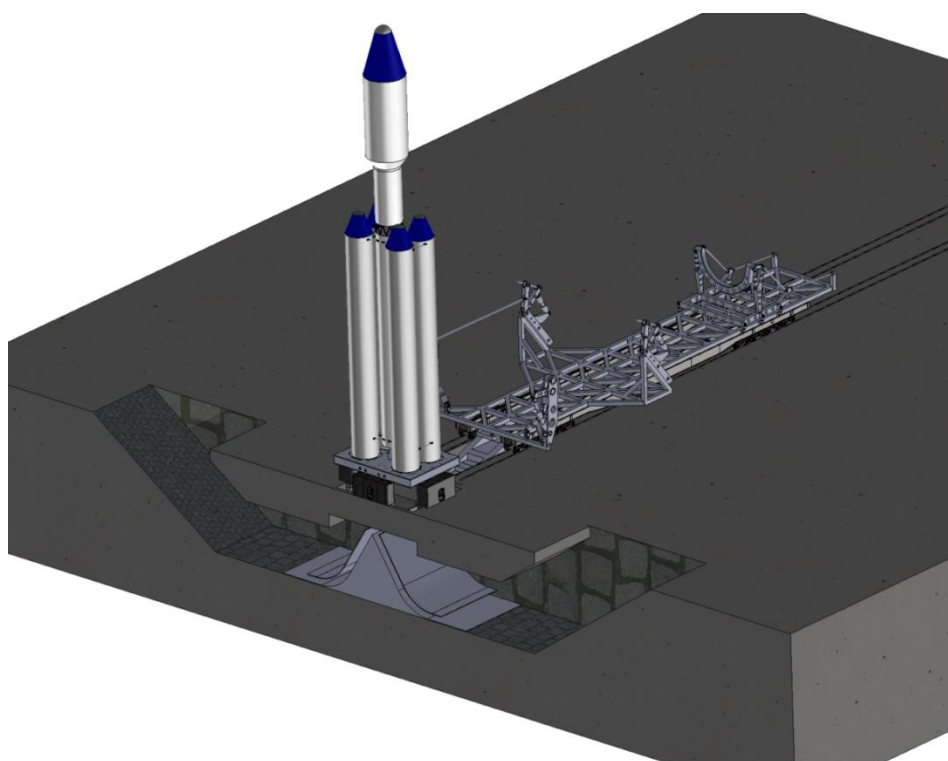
Общий вид стартовой системы для РКН с четырьмя боковыми блоками
